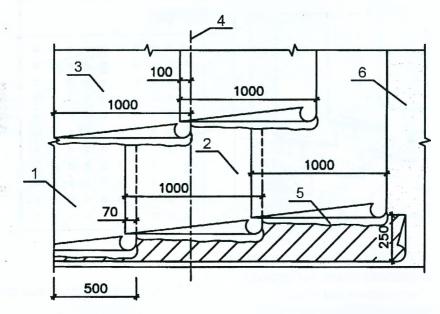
Устройство двухслойной рулонной кровли: 1—уравнительное полотнище; 2—полотнище внутреннего слоя; 3—полотнище наружного слоя; 4—меловая разметка на стяжке; 5—мастика; 6—выравнивающая стяжка
